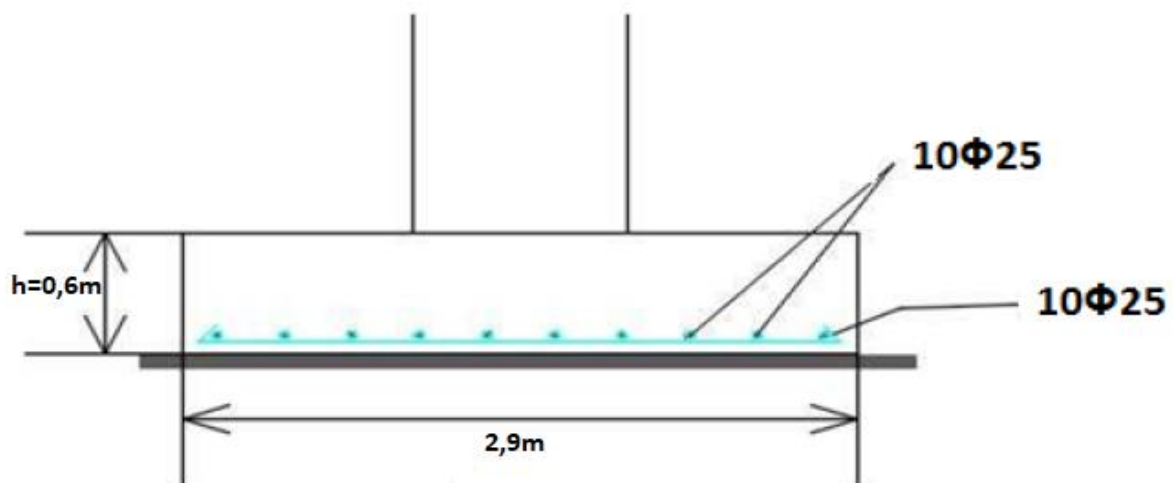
Dimension des semelles et disposition constructive des armatures.
